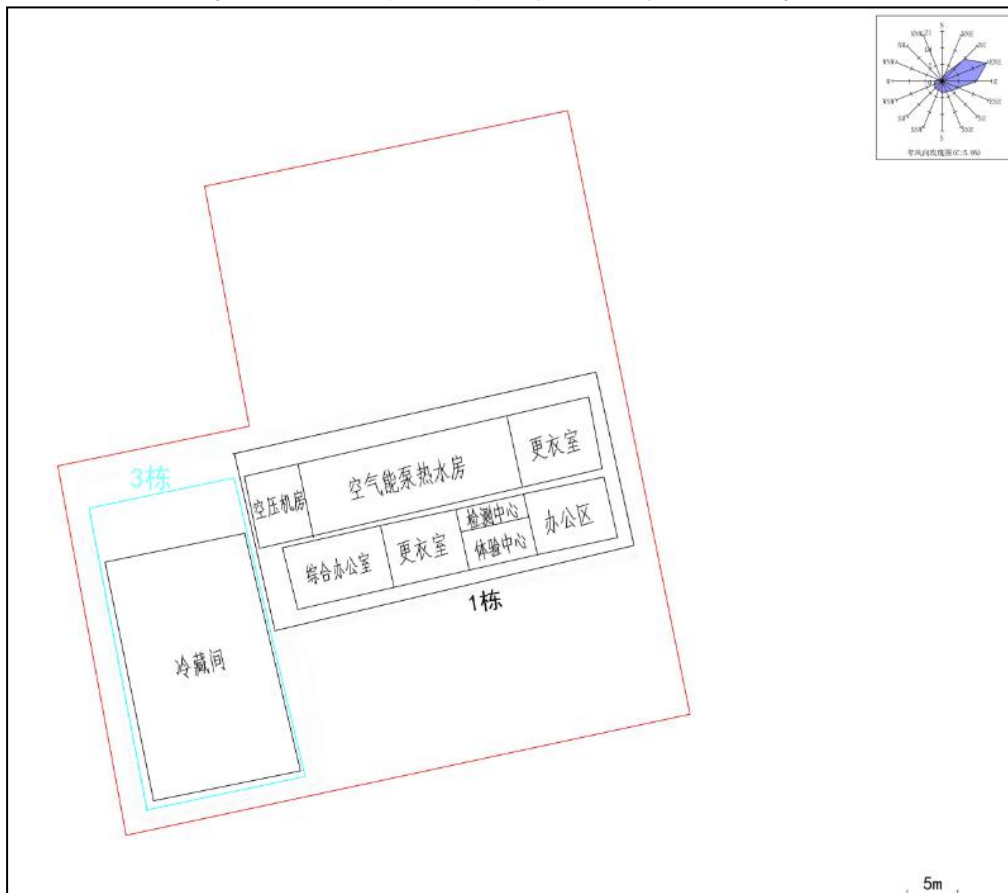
1 号建筑物、3 号建筑物二层平面布置图
